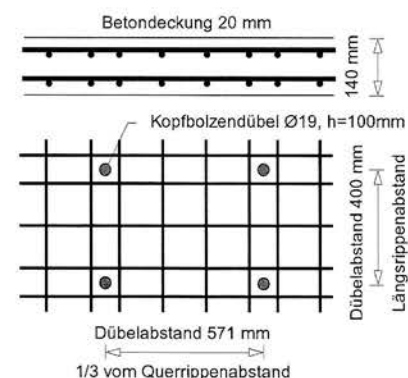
Versuchsmodell – Stahldeck- und Betonplatte
